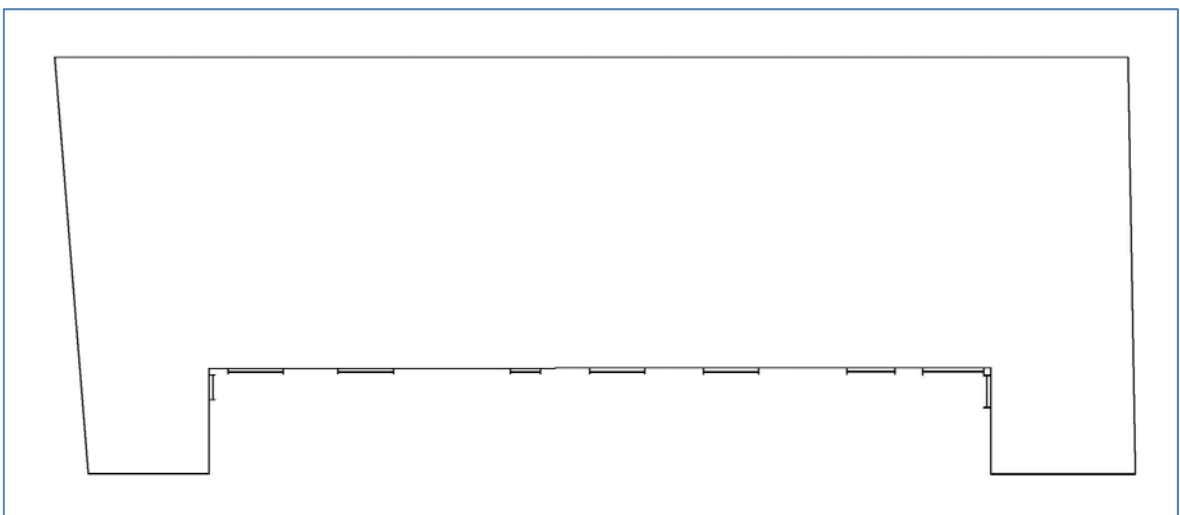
Silueta efectuada a partir del plano de planta buhardilla del Proyecto de Ejecución. (Efectuada por la cara interior de la fachada).
